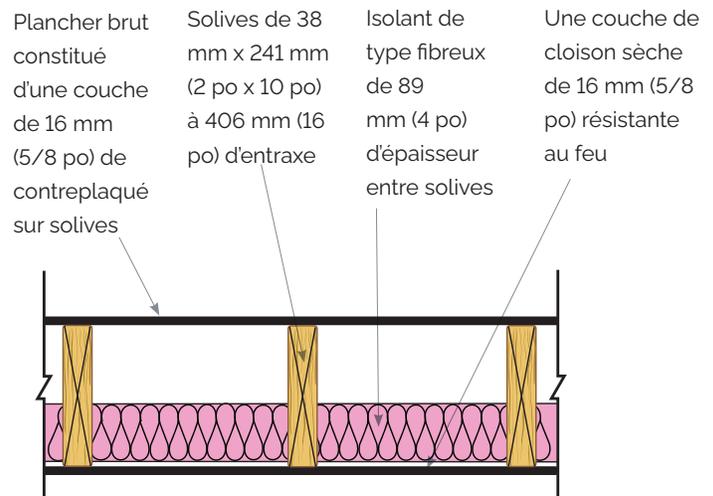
Schéma d'un plafond/plancher typique qui permettrait en général d'obtenir une séparation coupe-feu de 30 minutes
